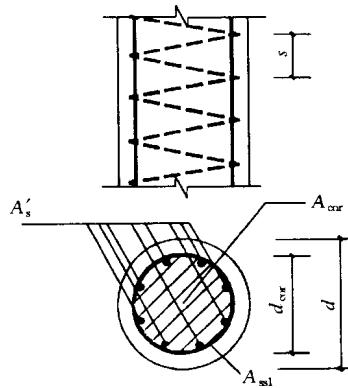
配置螺旋式间接钢筋的钢筋混凝土轴心受压构件
